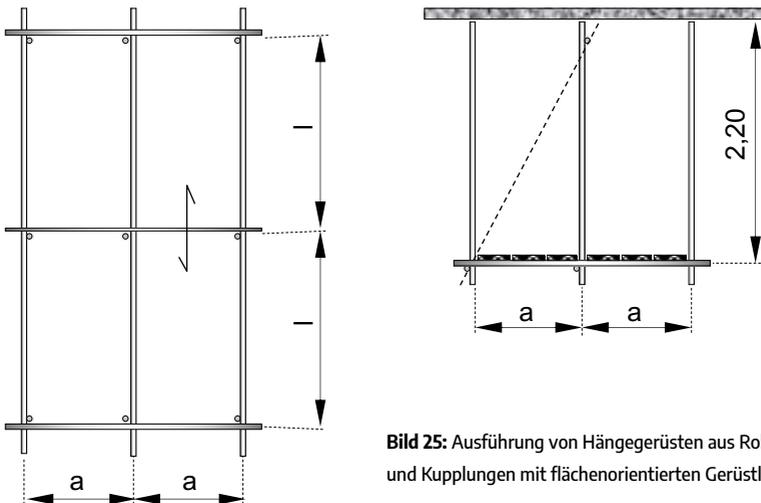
Ausführung von Hängegerüsten aus Rohren und Kupplungen mit flächenorientierten Gerüstlagen
